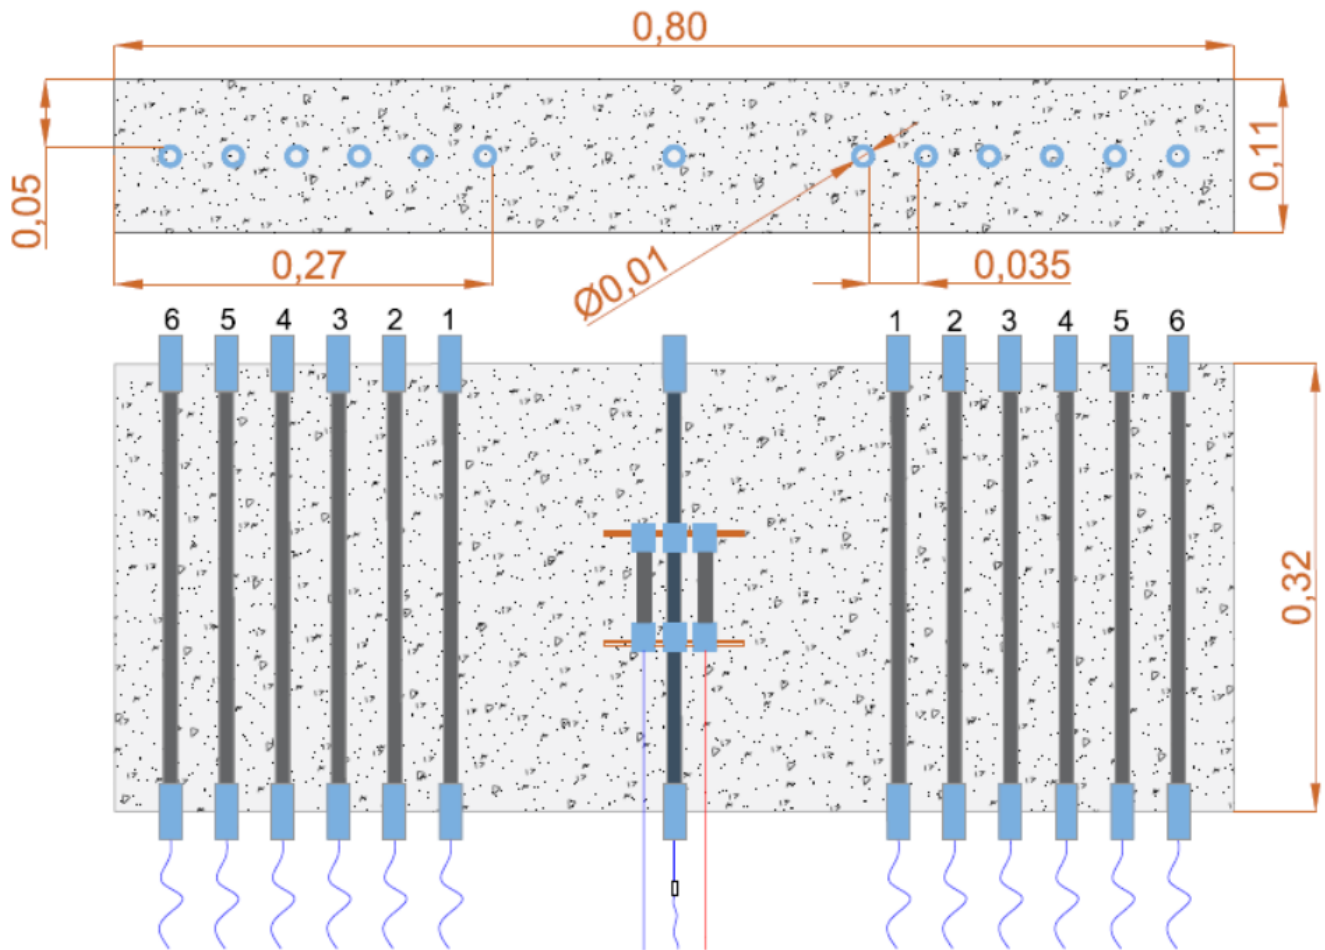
Planta y perfil de prototipos de ensayo.
